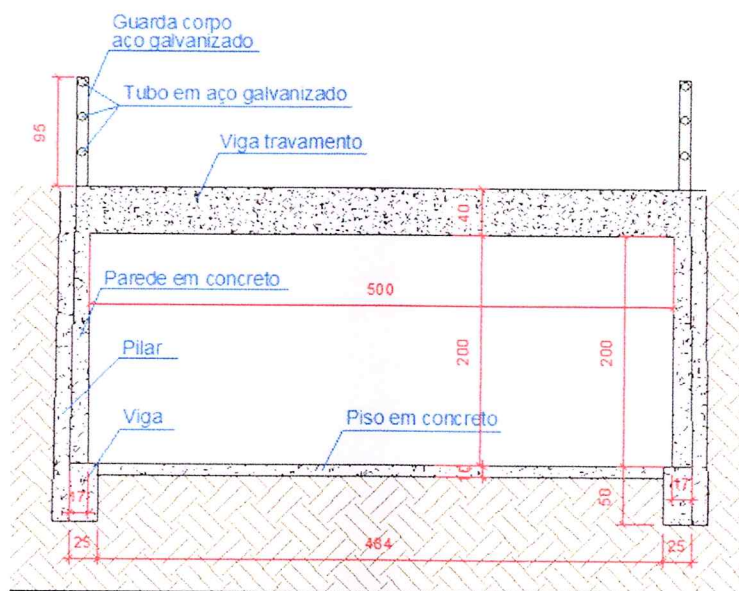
Trecho em concreto moldado “in loco”, obras atualmente
